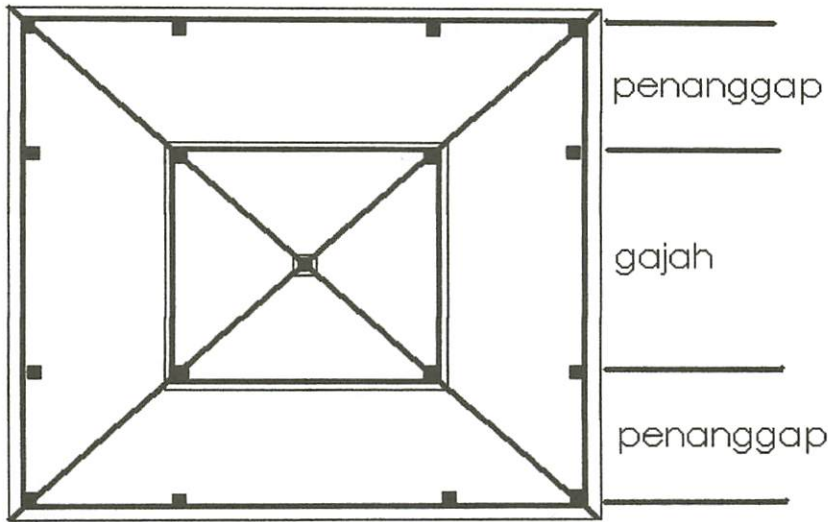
Bentuk Bangunan Tipe Kumpang
